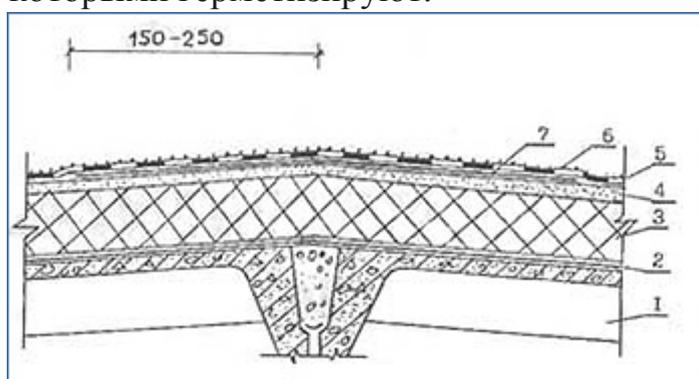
Конёк кровли: 1 - железобетонная плита покрытия; 2 – пароизоляция; 3 – теплоизоляция; 4 - цементно-песчаная стяжка; 5 - основной кровельный ковёр; 6 - крупнозернистая посыпка верхнего слоя наплавляемого рулонного материала; 7 - дополнительный слой кровли.
